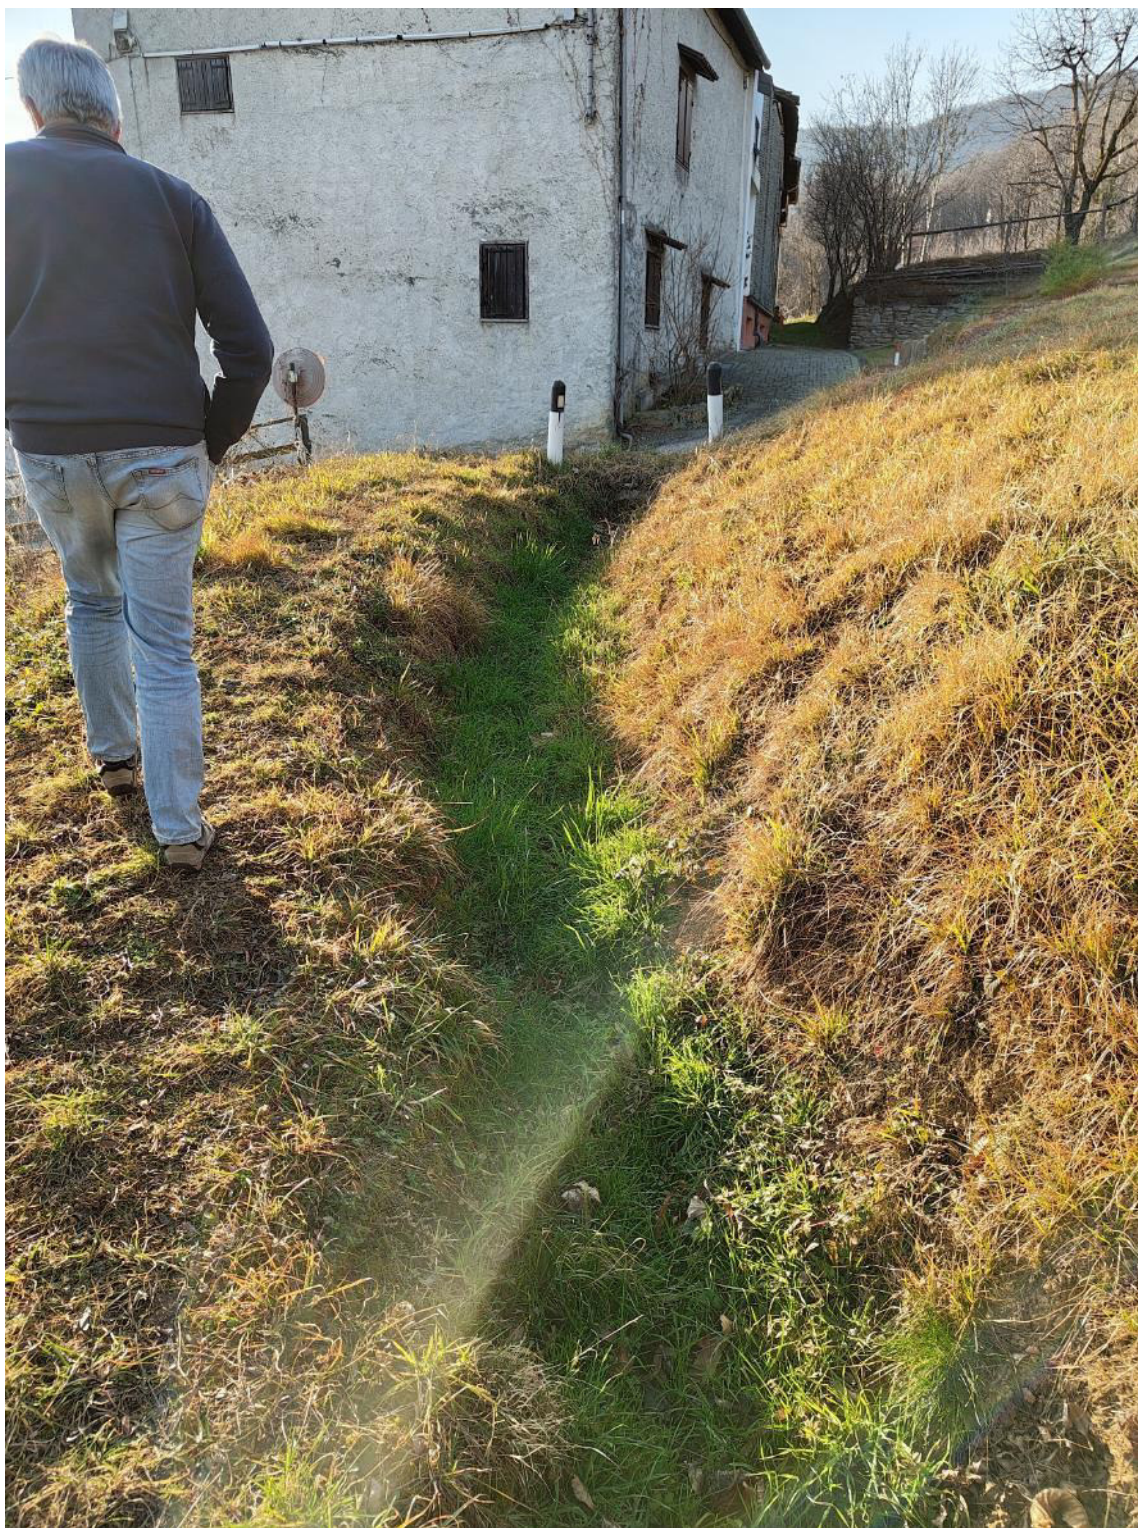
Vista 1 stato attuale dell'area di intervento 12 –sistemazione canaletta in terra con posa di tubazione mezzi tubi in PVC – Via Santa Elisabetta.
